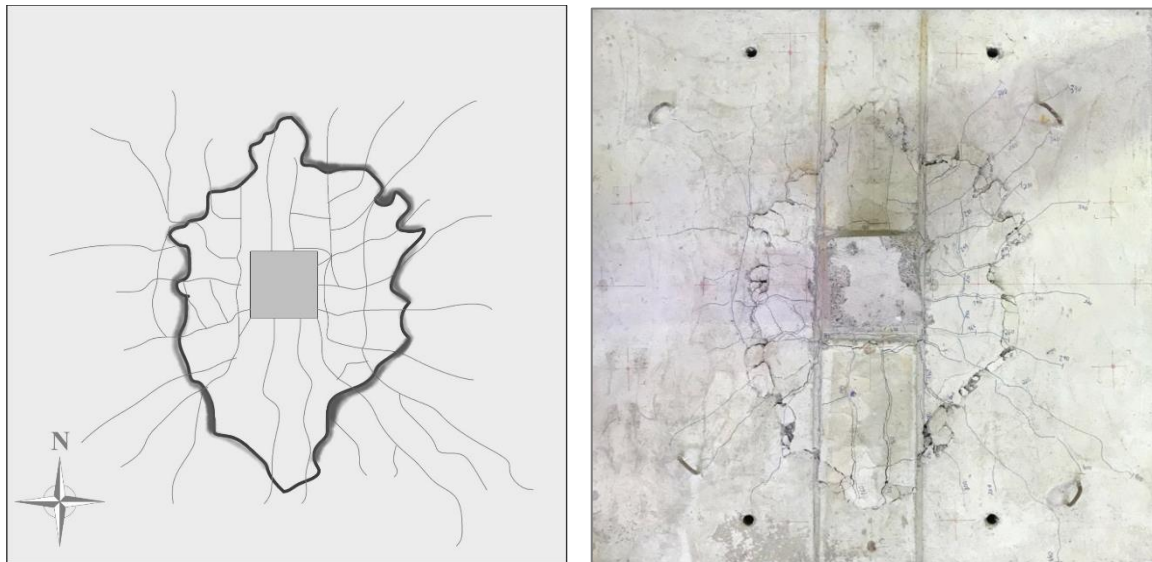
Mapa de fissuração da laje RS
